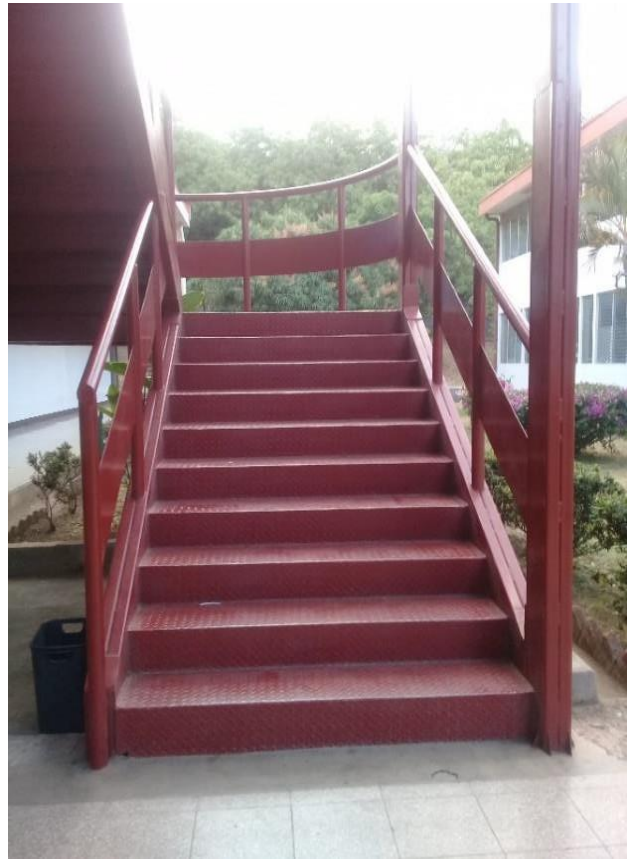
Vista Frontal, escaleras metálicas Pabellón 11.
